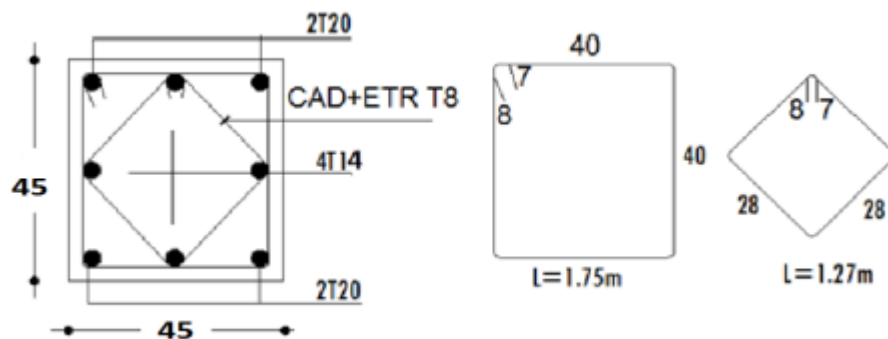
Coupe du ferrailage des poteaux 45x45
